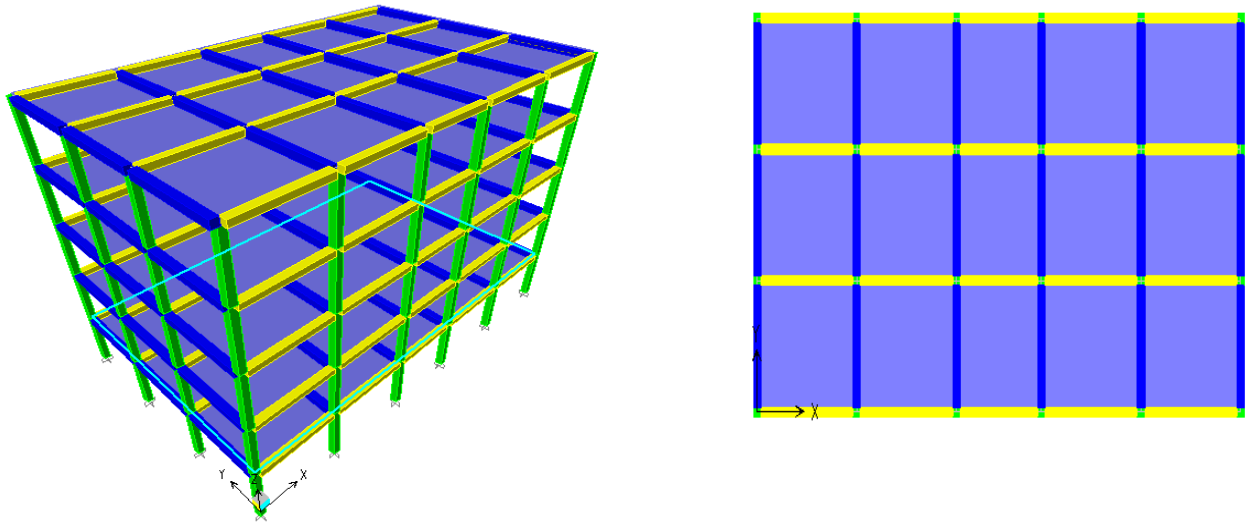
Vue en plan (2D) et en (3D) du bâtiment rectangulaire
